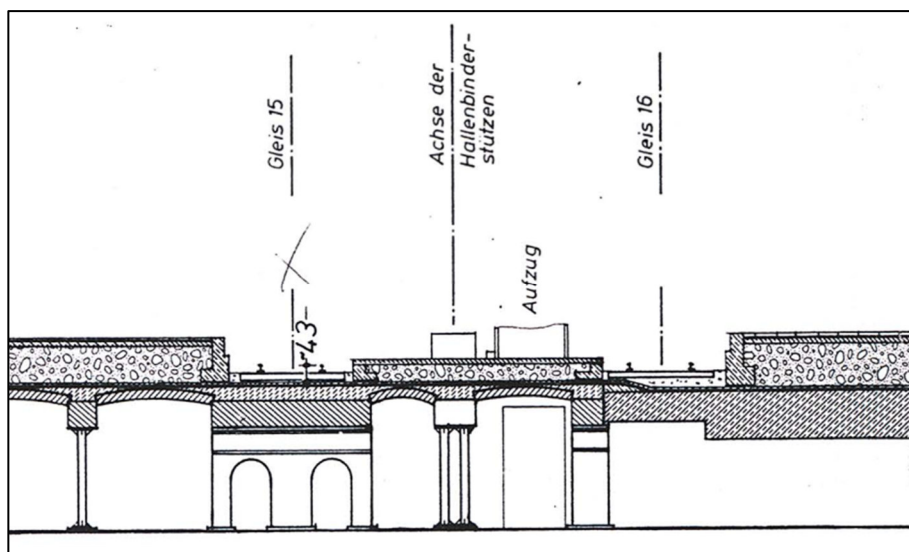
Auszug aus Bestandsplan – Längsschnitt Posttunnel
